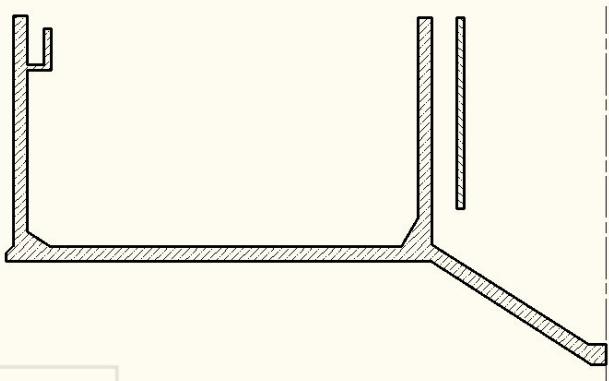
Головний вигляд базисів для формування корпусу споруди і напівзануреної перегородки
